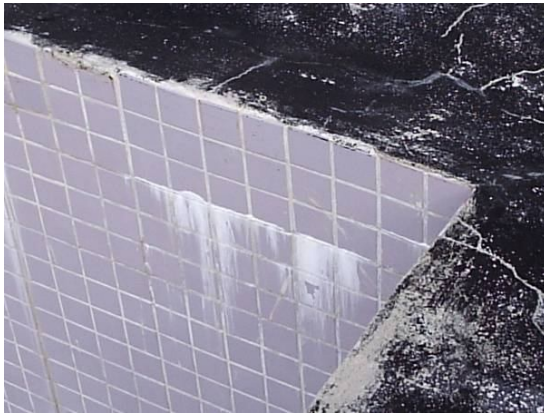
Acervo do Autor – Exemplo de eflorescência gerada pela ausência de mureta perimetral de contensão, aliada a escolha de sistema de impermeabilização inadequada.
